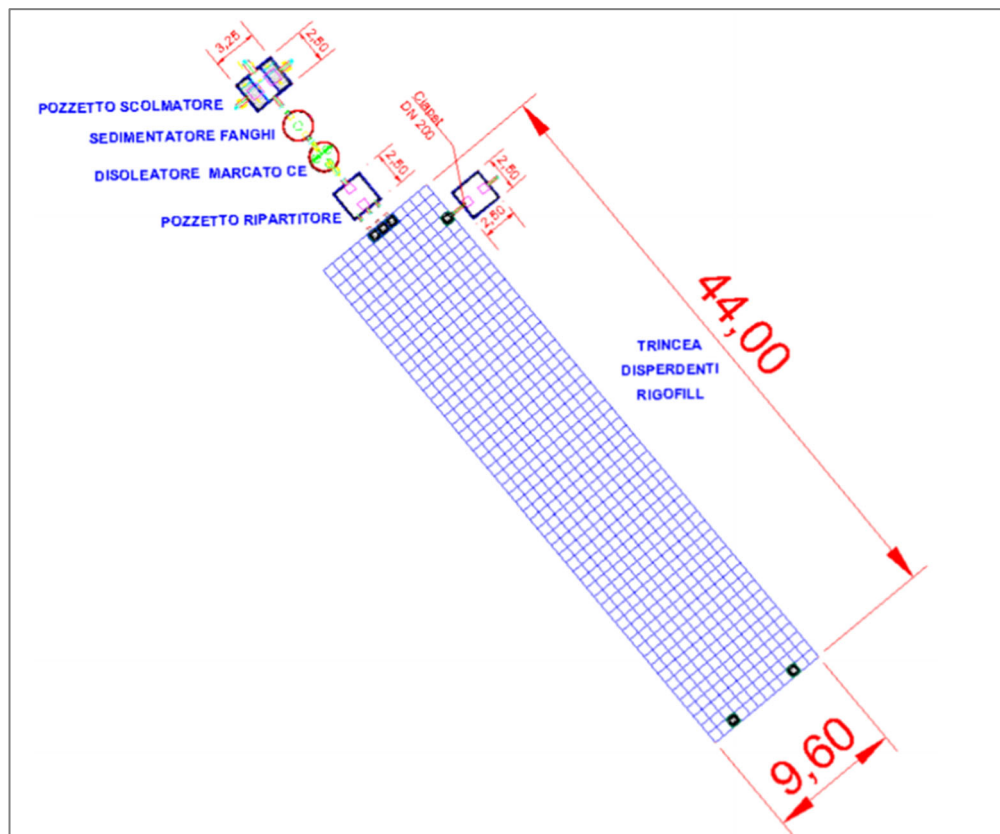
Area privata Esselunga – schema planimetrico sistema disperdente
